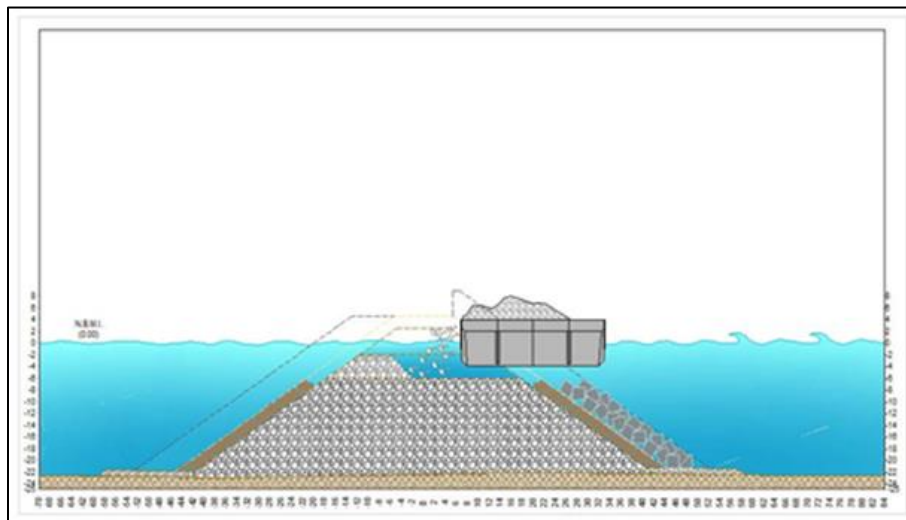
Colocación de Núcleo con Pontón de descarga lateral desde la cota -6 hasta la cota -2 m
